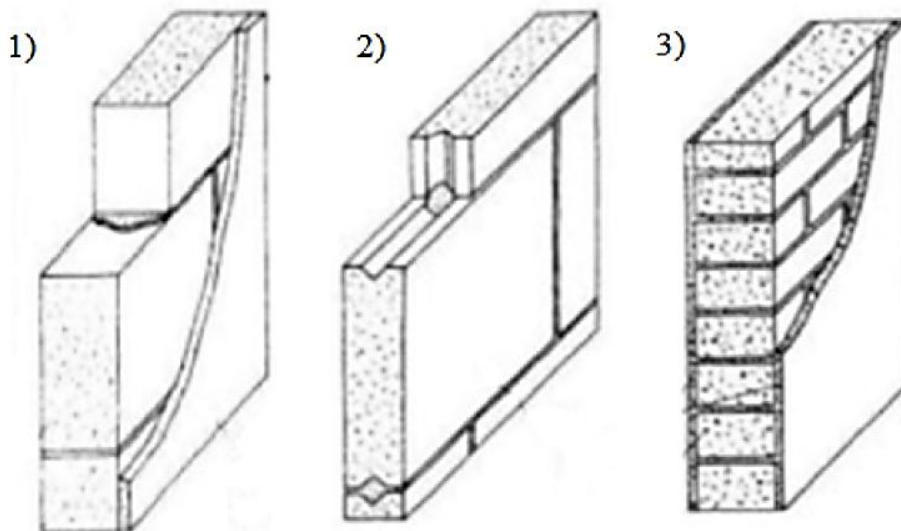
Варіанти перегородок, що порівнюються: 1) – перегородка з бетонних блоків; 2) – з легкобетонних плит; 3) – з керамічних каменів
